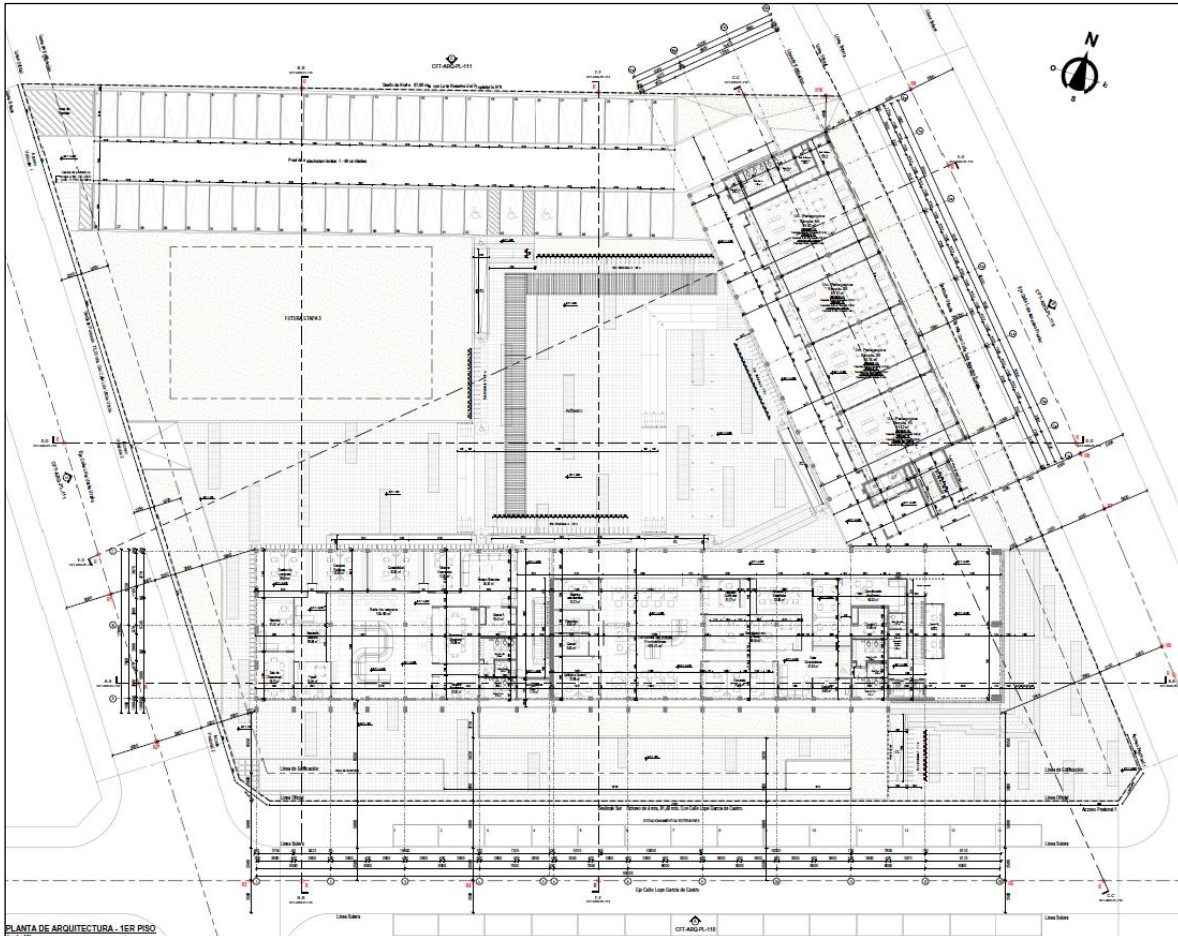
Edificaciones proyectadas, planta arquitectura primer piso
